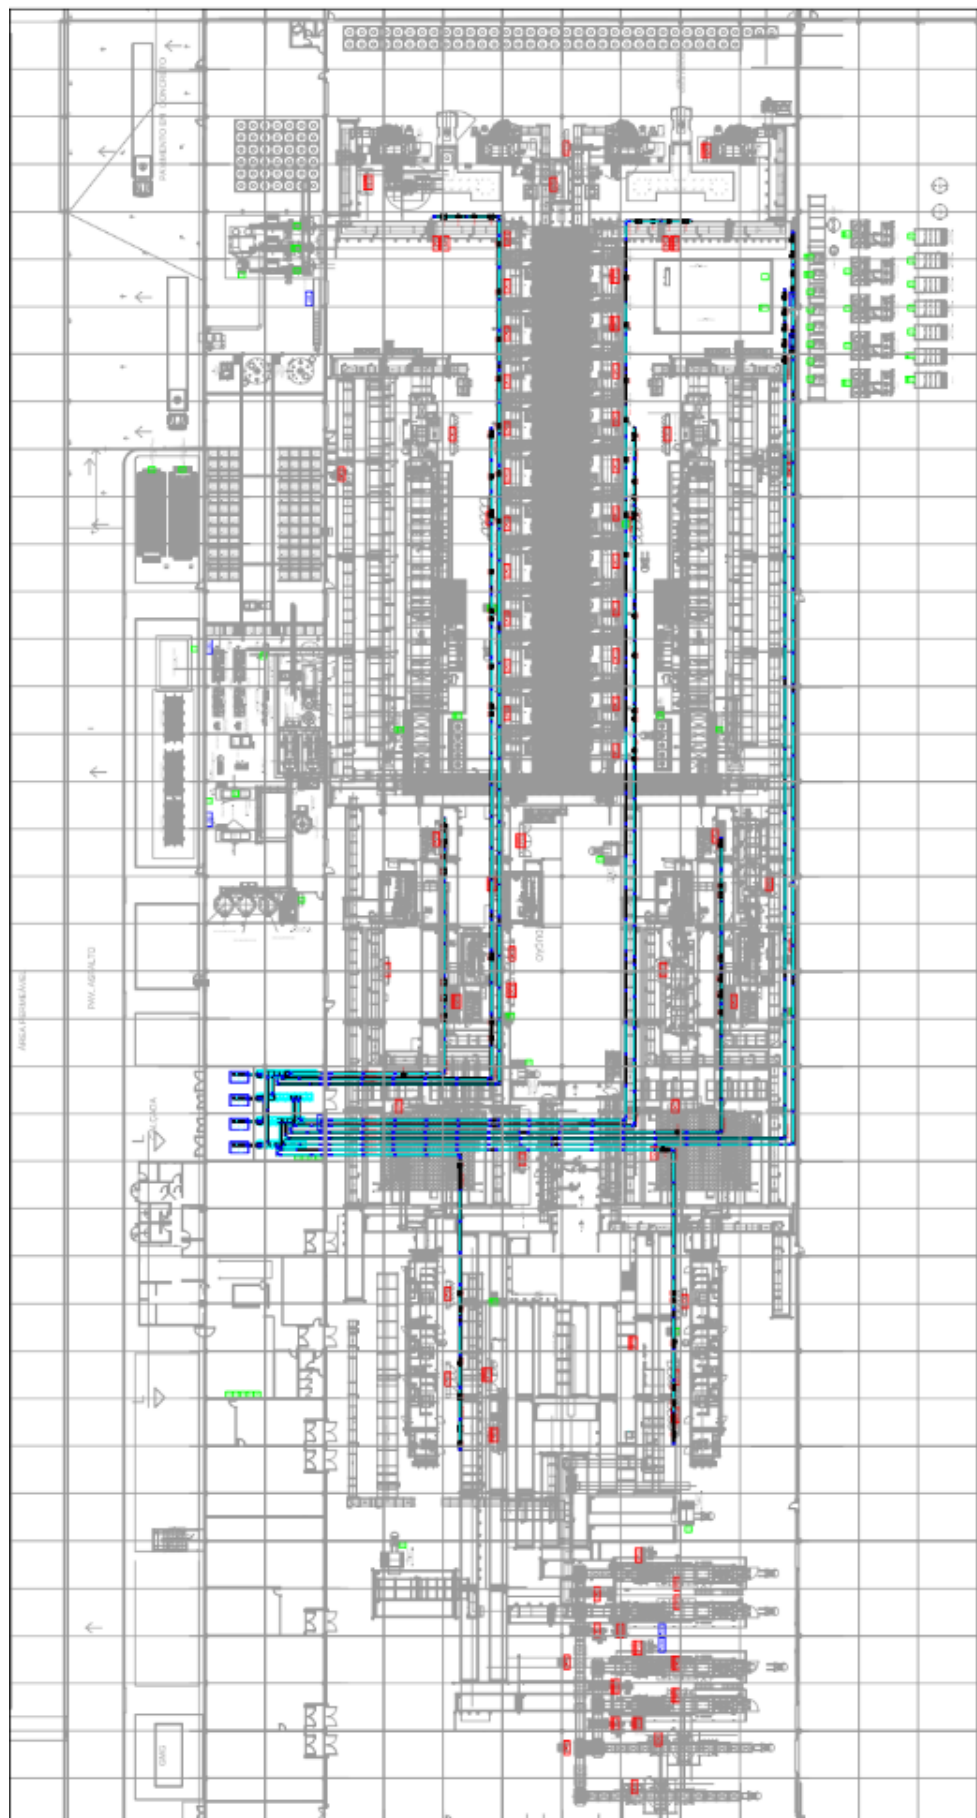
Planta Baixa dos barramentos e linhas de cabo. Fonte [Autor].
